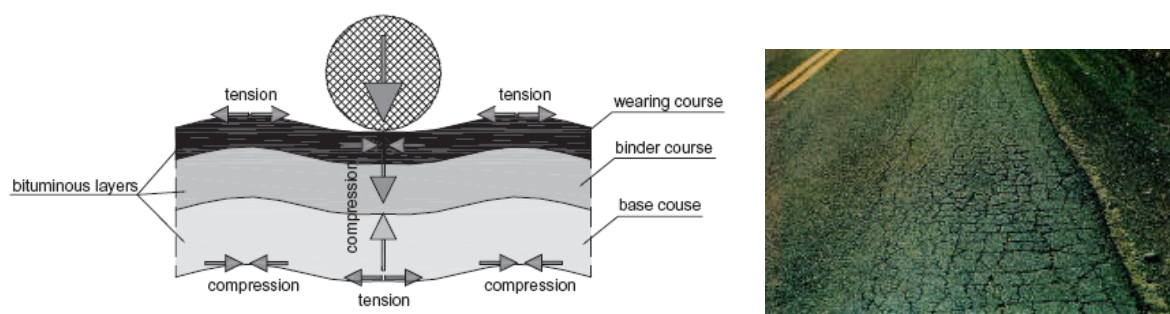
42 Tensiones y deformaciones producidas por cargas de tráfico en las capas bituminosas del firme, y pavimento fisurado severamente por fatiga.
